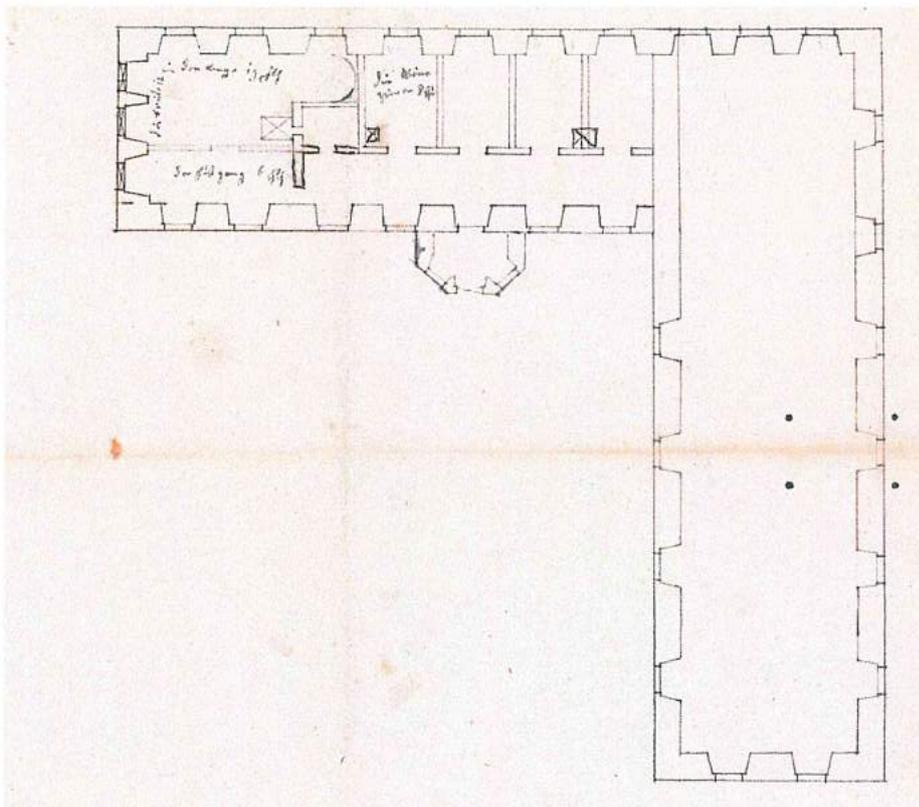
Schloss Kirchhofen, Grundrisszeichnung des Erdgeschosses, um 1740,
